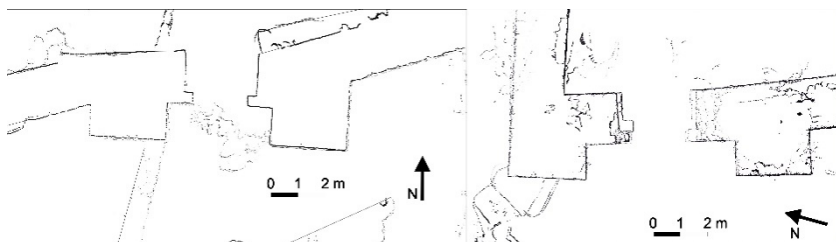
Plantas de las puertas de acceso a la madina de Vascos, realizadas por secciones del levantamiento con Láser Escáner Terrestre de la muralla del yacimiento (fuente: autor)
